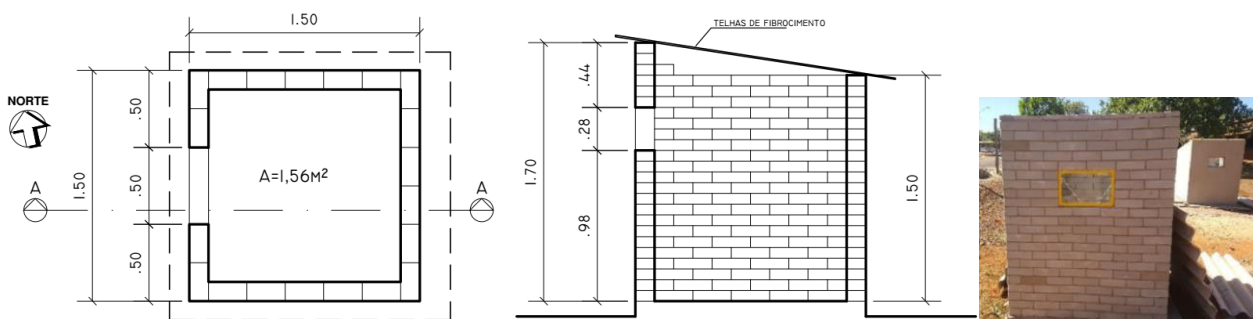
Planta Baixa e Corte células-teste. Escala 1/50. Foto Fachada Oeste, sem telhado.
